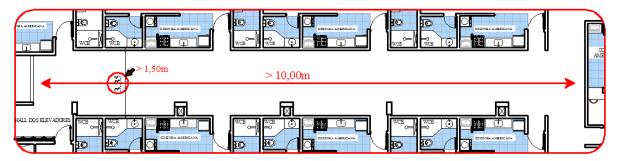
Circulação no pavimento tipo 7º ao 11º pavimentos (Detalhe 15)
